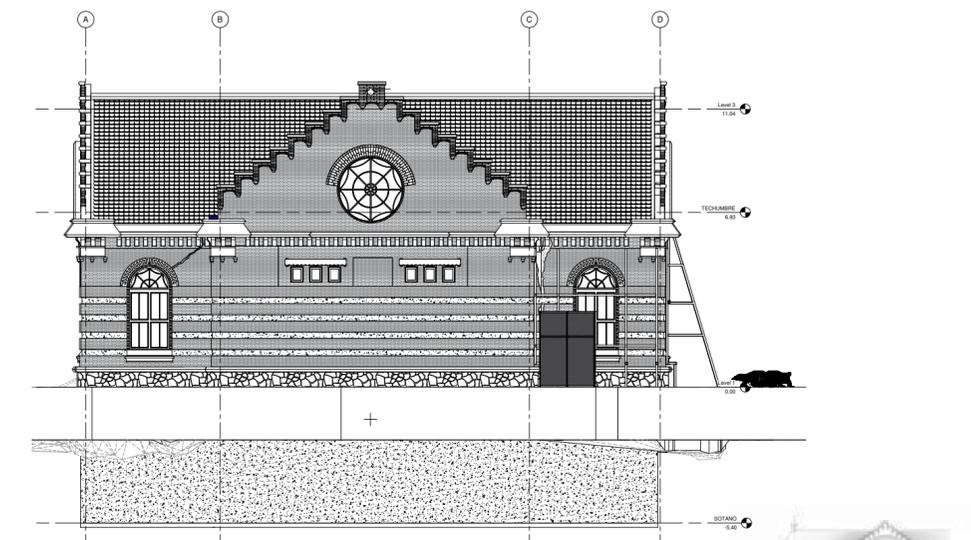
Fachada arquitectónica Oriente - estado actual.
